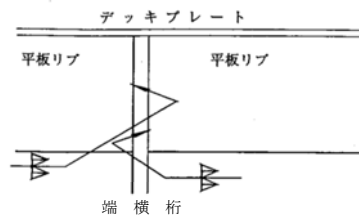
平板リブ又はバルブプレートリブと端横リブ又は端横桁の交差部構造の標準
